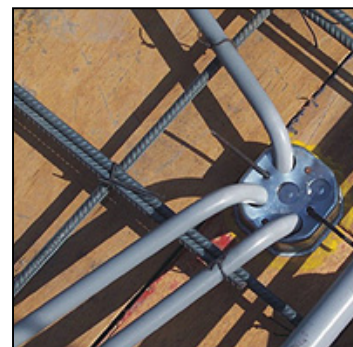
Adecuado Recubrimiento entre la Tubería y el Fondo de Losa
